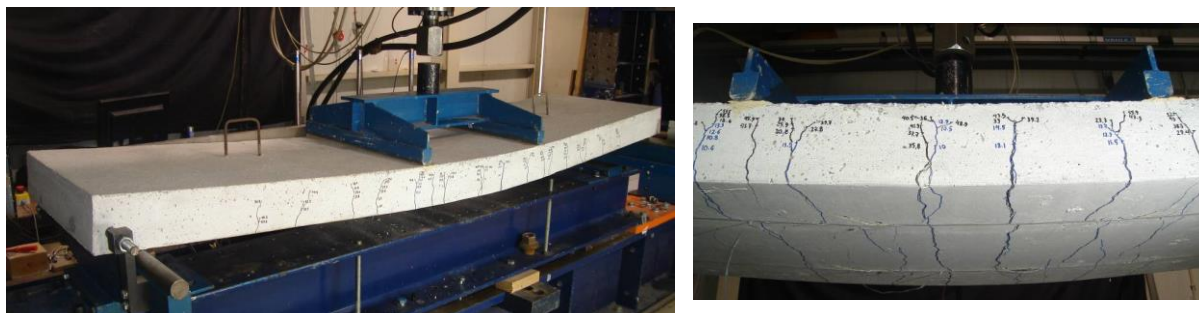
Laje S2L-PC1 após o ensaio à rotura e pormenor do modo de rotura.
